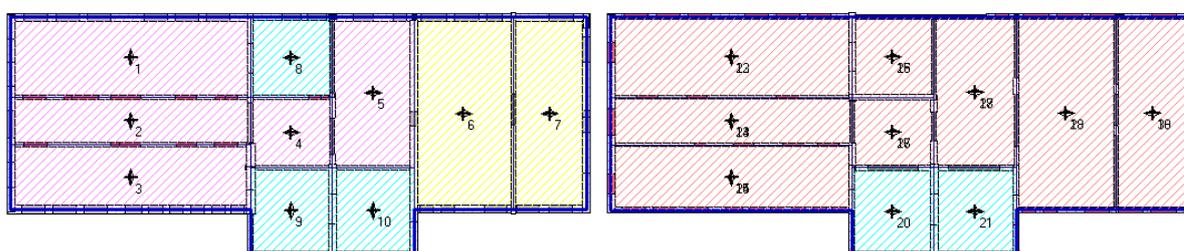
In alto: modellazione Corpo 1b. A sinistra: pianta solaio piano rialzato e centri di massa; a destra: pianta solaio piano sotto copertura e copertura e centri di massa. Fonte: Comune di Cesena
